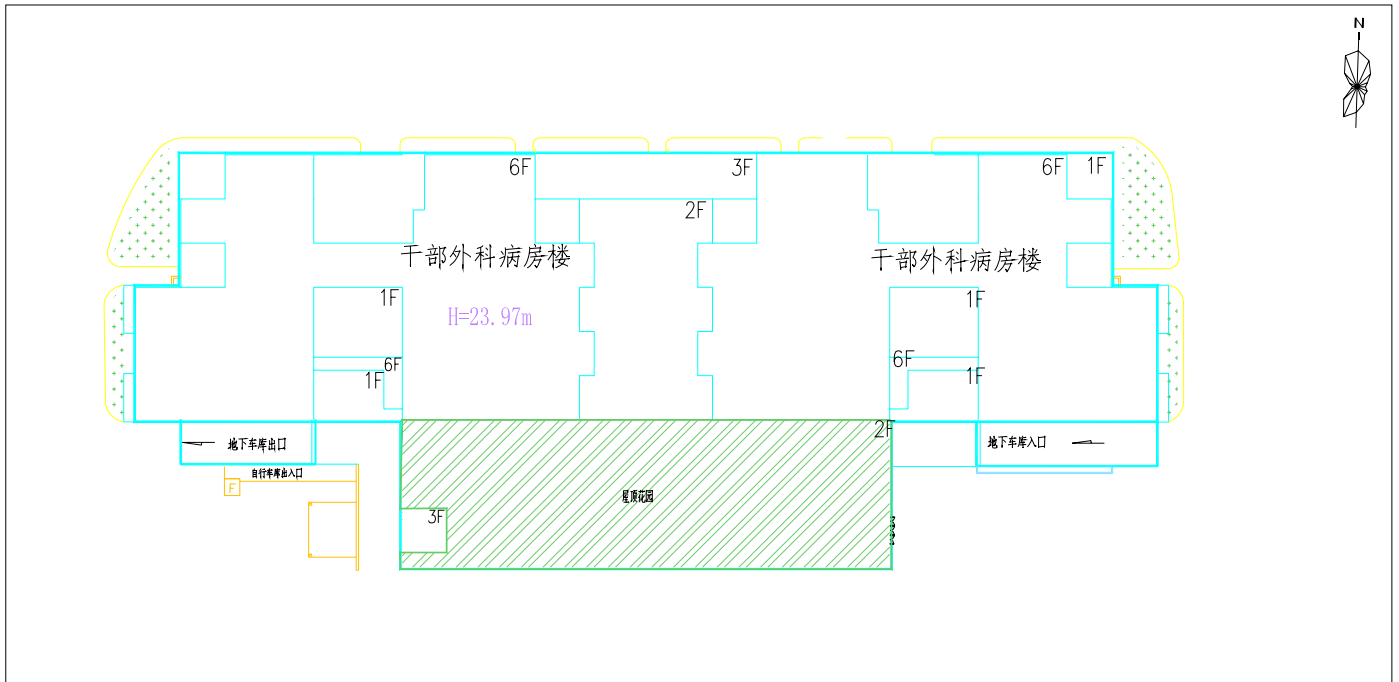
第二住院部干部外科病房楼总平面布置图
